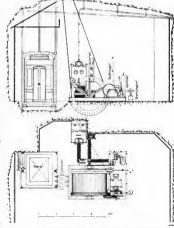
Die Maschinenkammer mit der Aufzugswinden-Einrichtung. Masstab 1:100. - Gebaut von C. Wuit & Cie. in Seebach-
